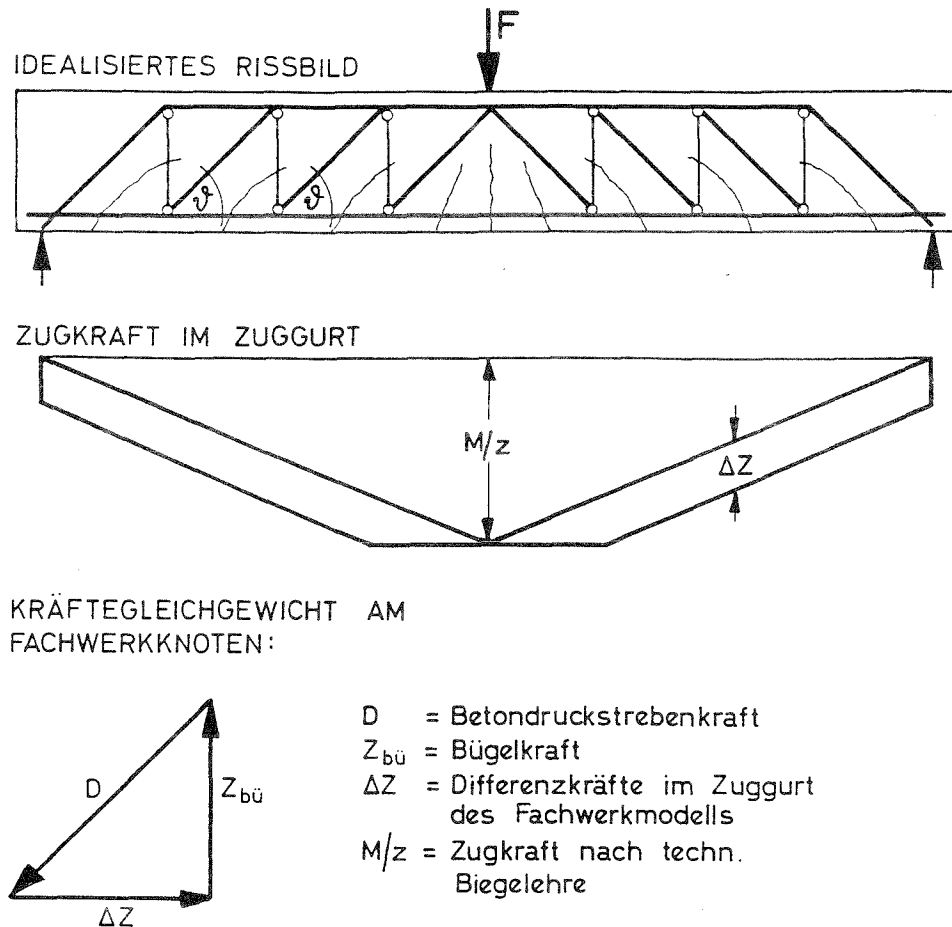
Fachwerkmodell für die Bemessung verbundlos vorgespannter Stahlbetonträger nach Kordina/Hegger [7]
